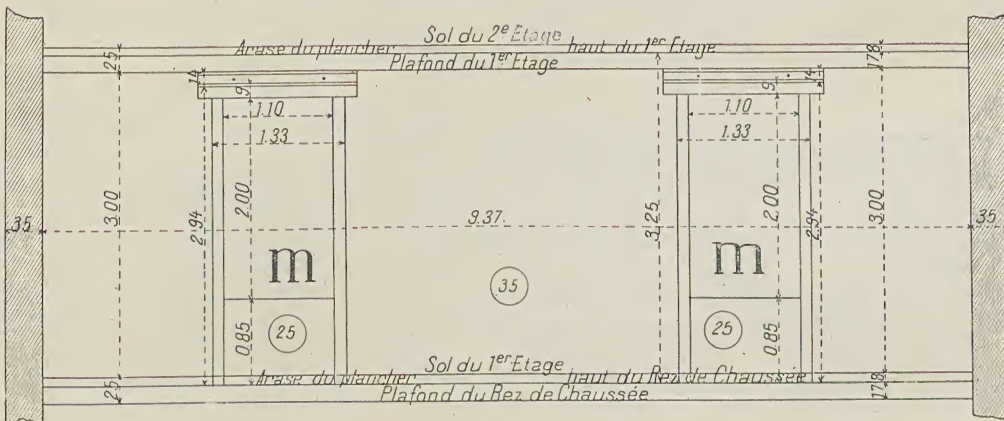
Façade latérale de droite ; élévation vue de l'intérieur
